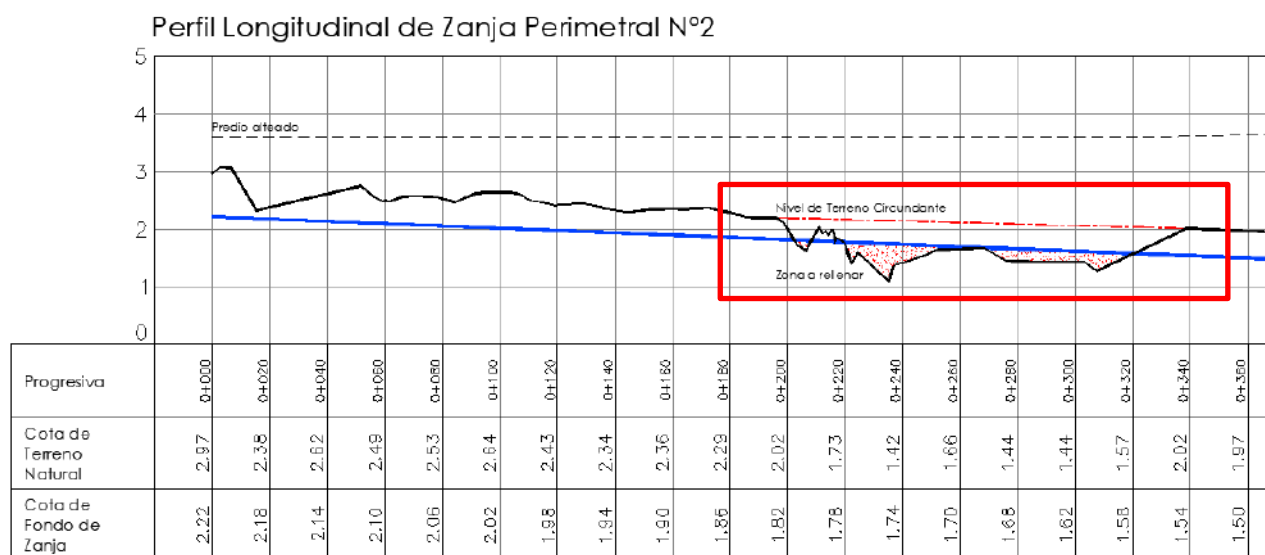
Perfil Longitudinal zanja perimetral 2 en zona de bajo
